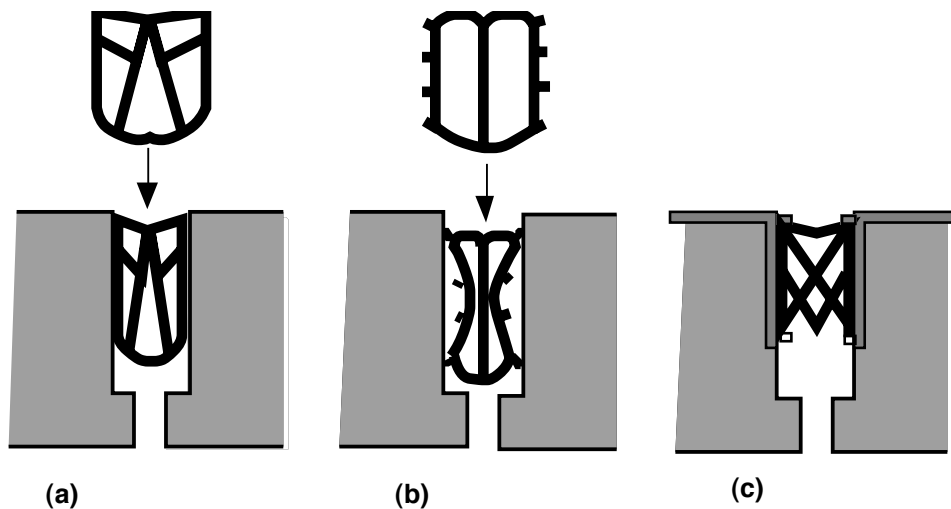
Grundformen schlauchartiger Mehrkammerdichtungen für Baukörperfugen
